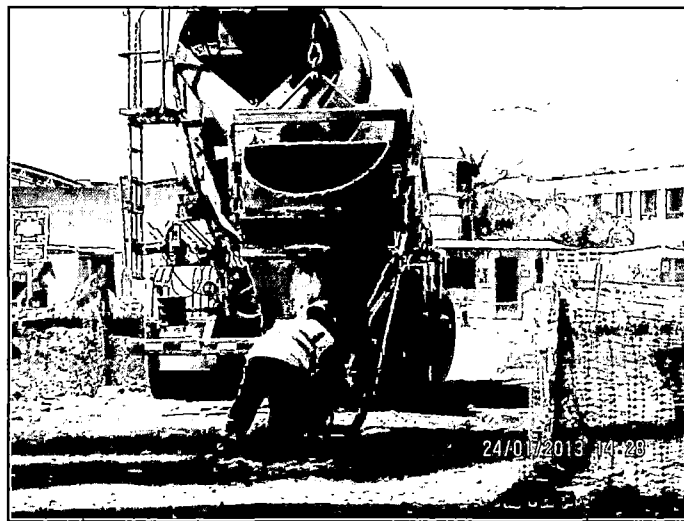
Rigger exterior maniobrando el balde de concreto
